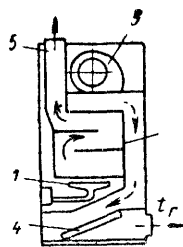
Напольный газовоздушный отопительный агрегат
